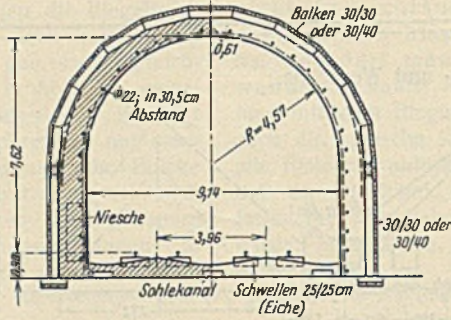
Querschnitt des neuen Tunnels in Strecken geringeren Drucks.
